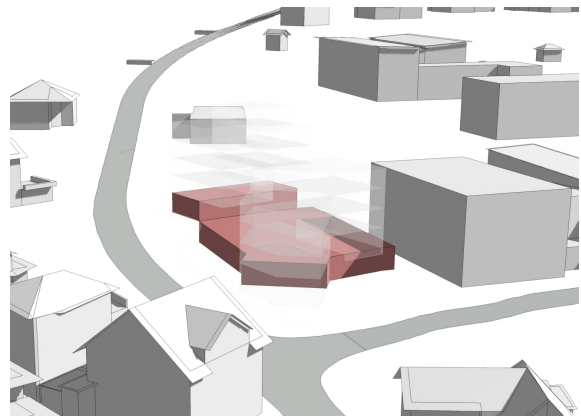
3D Visualisierung der Einstellhalle, eigene Darstellung auf Grundlage swissBUILDINGS swisstopo
